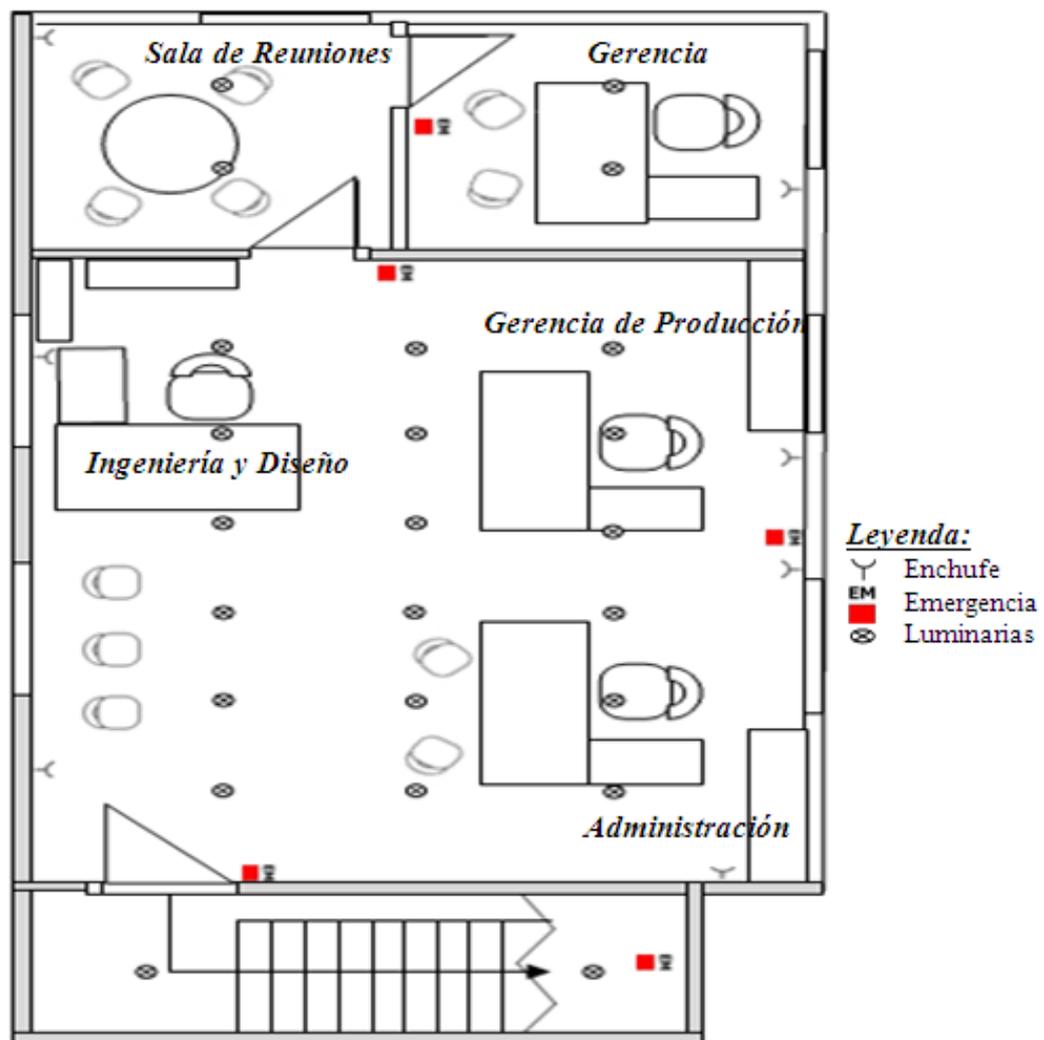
Croquis de distribución de la Planta Primera (Elaboración propia).
